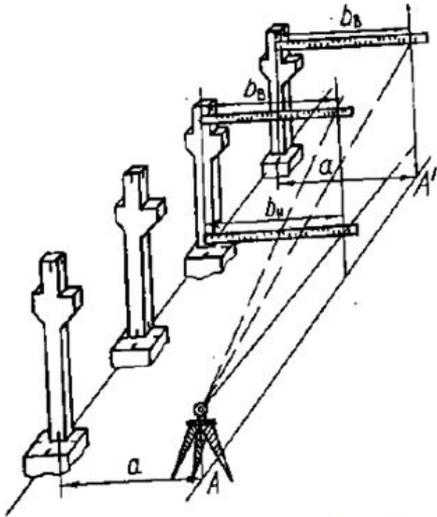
Контроль установки ряда колонн способом бокового нивелирования
